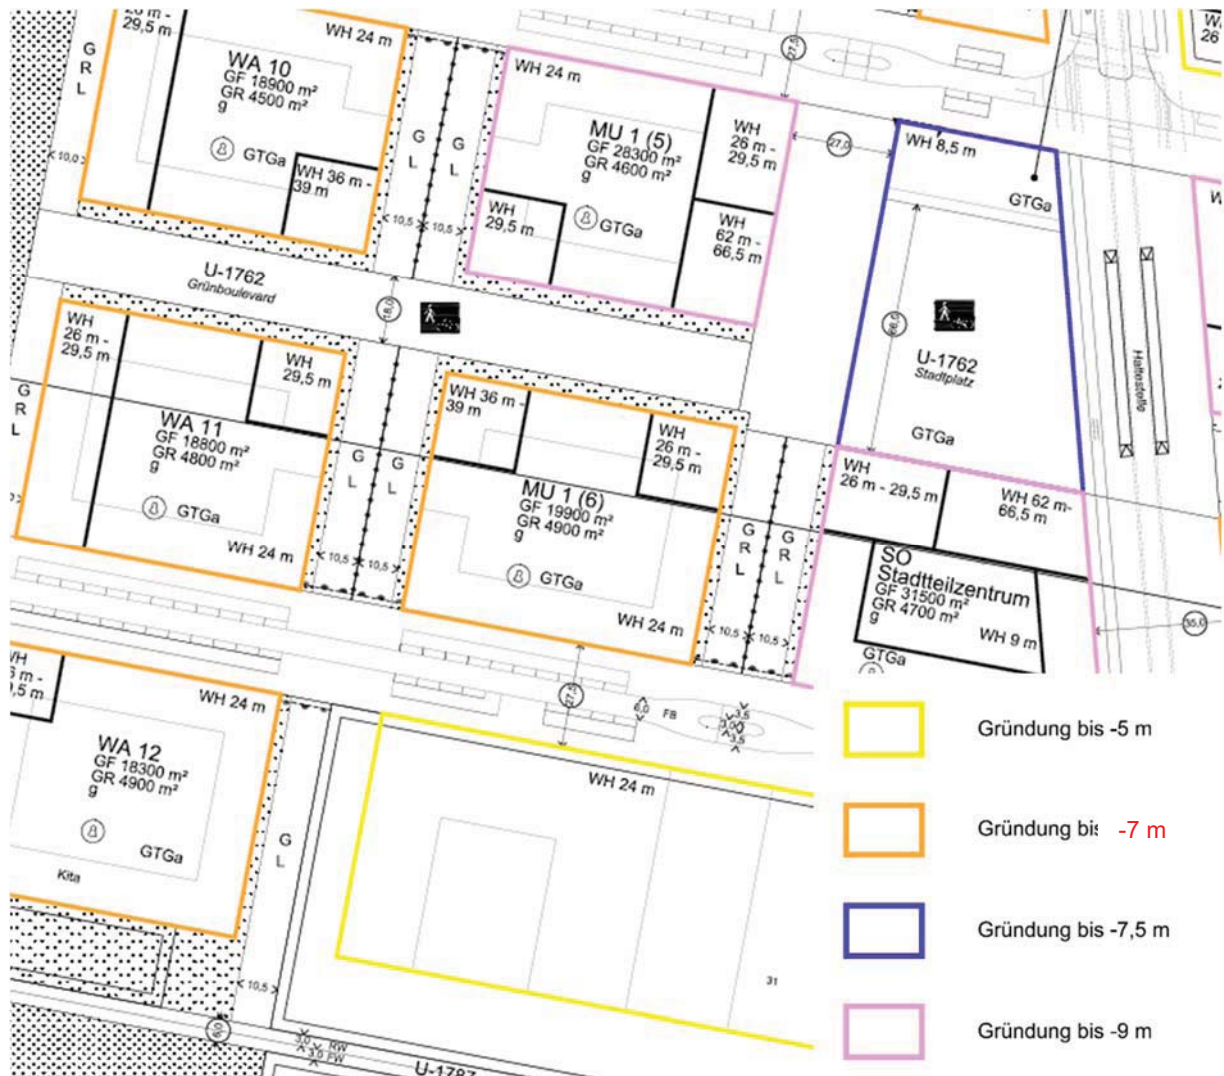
Baufeld MU 1(6) – Bebaubarkeit gemäß Baurecht (Ausschnitt aus (3))
